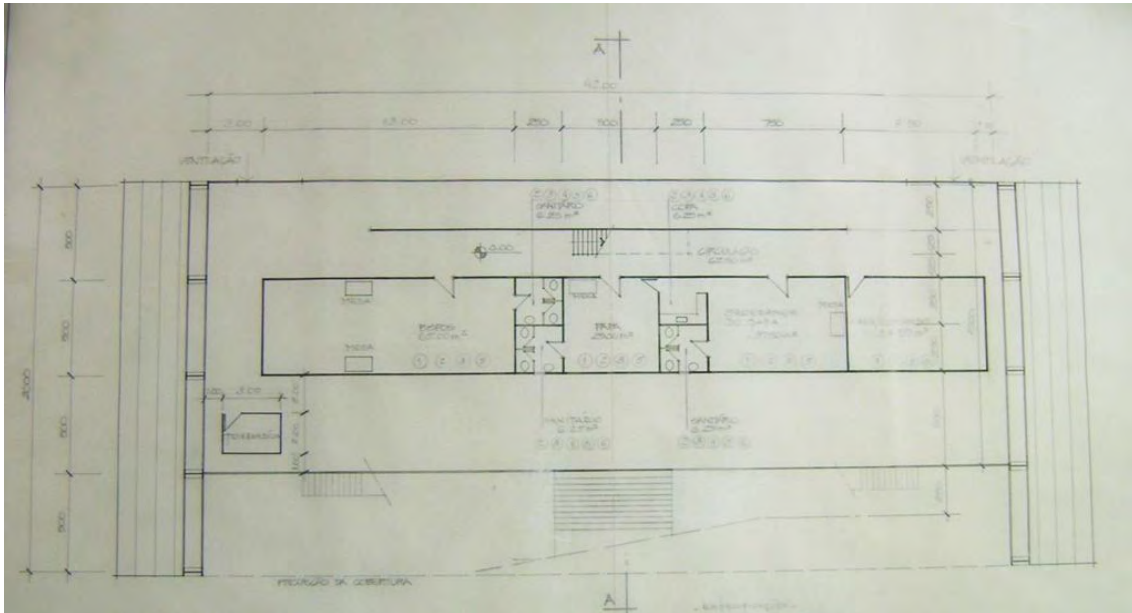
Planta Baixa nível 0. Junho de 1991.
